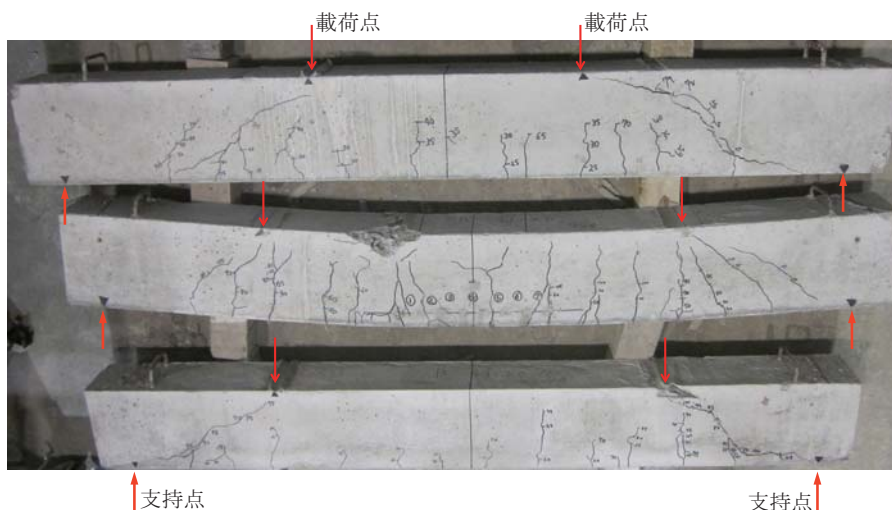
異なる荷点および配筋量より曲げモーメントを受ける鉄筋コンクリート単純梁のひび割れへの影響
